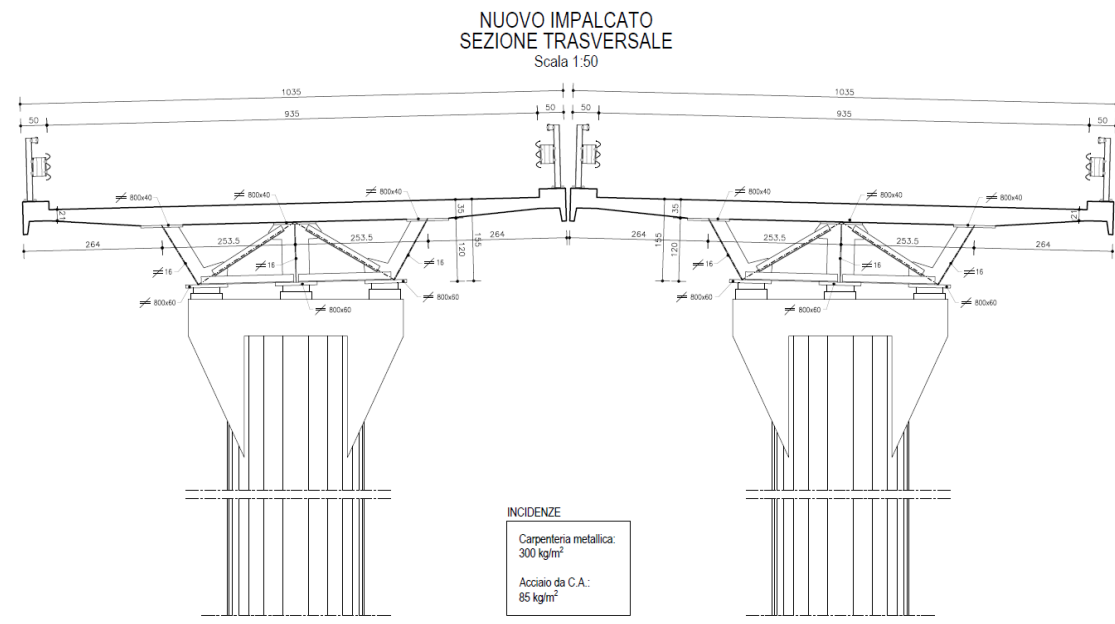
Sezione tipo nuovo impalcato acciaio-calcestruzzo
